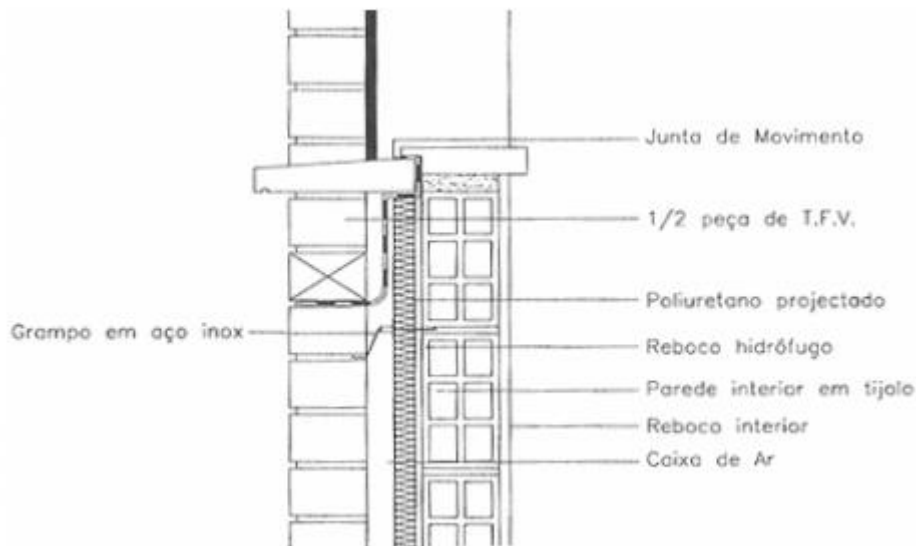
Corte em zona de vão com destaque para a impermeabilização do parapeito [21]
